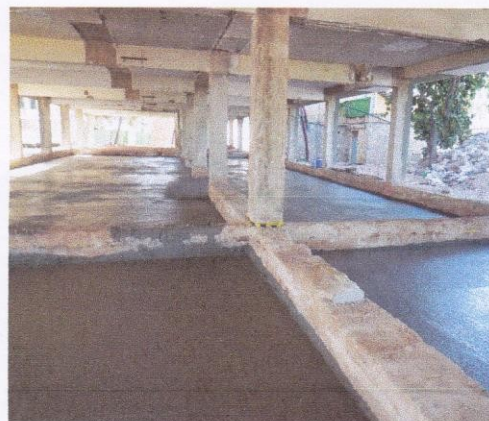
y 4 (05/10/10): colocación de angular en la esquina de uno de los pilares para su refuerzo, retacado con mortero.
